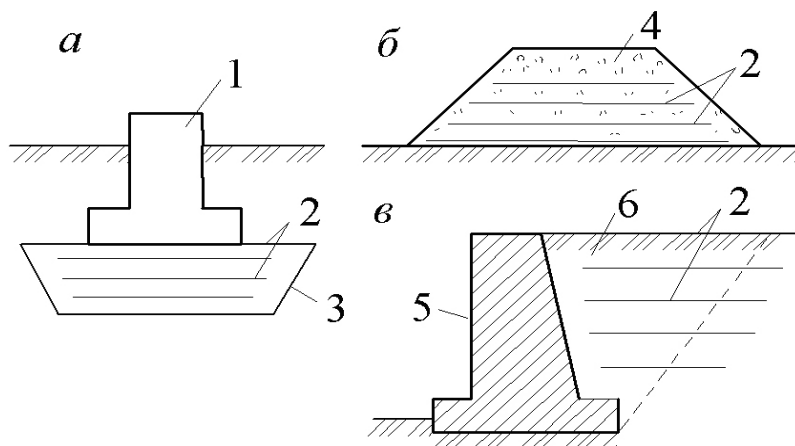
Усиление грунтового основания под фундаментом армированием (а), при устройстве насыпи (б), обратной засыпке (в): 1 – фундамент; 2 – армирующие элементы; 3 – песчаная подушка; 4 – насыпь; 5 – подпорная стенка; 6 – призма обрушения
